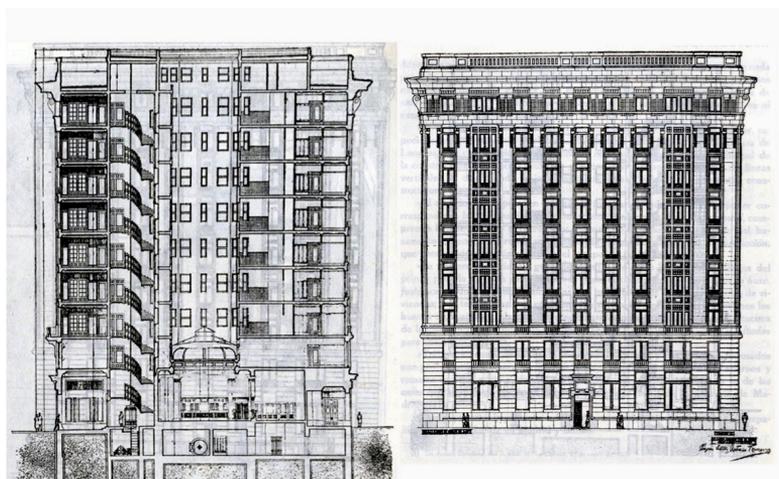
Sección y alzado de la fachada lateral del Banco Pastor, en La Coruña. Arquitectos Antonio Tenreiro Rodríguez y Peregrín Estellés Planells. 1922. *Revista de Arquitectura*, 37 (mayo de 1922), pp. 217-218
